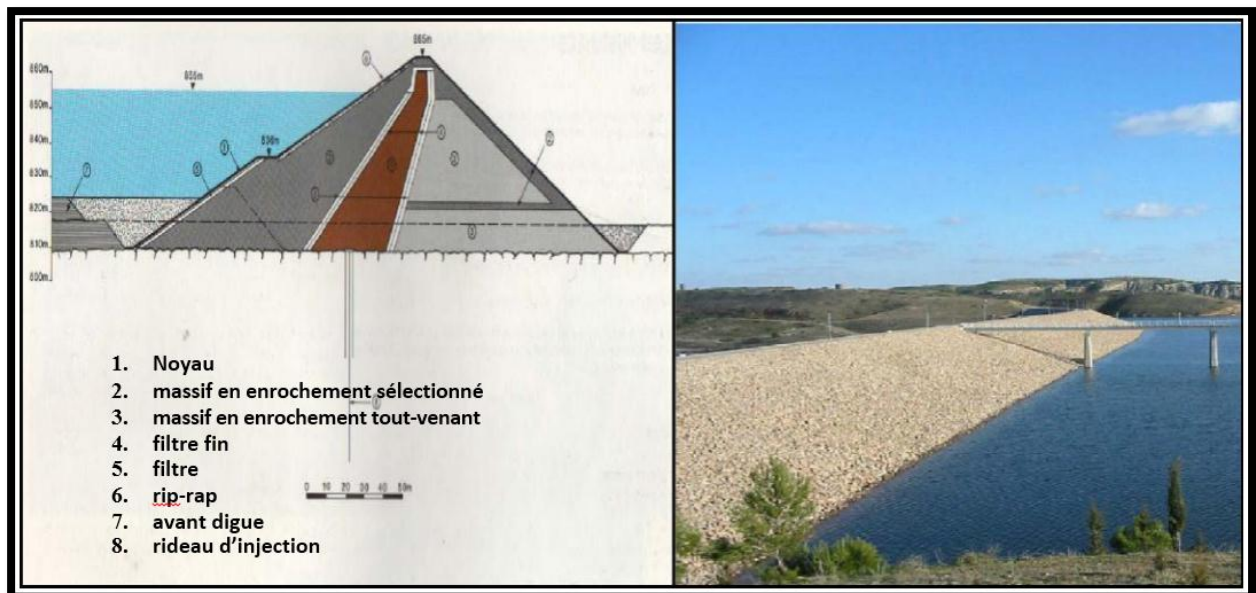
Photo de la digue principale et coupe en travers du barrage d'Ain Zada
